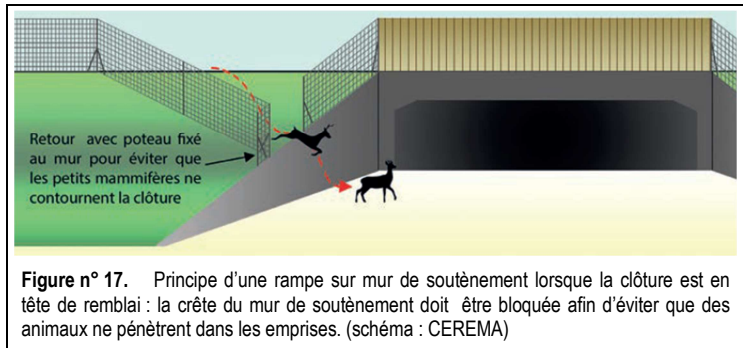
Principe d'une rampe sur mur de soutènement lorsque la clôture est en tête de remblai : la crête du mur de soutènement doit être bloquée afin d'éviter que des animaux ne pénètrent dans les emprises. (schéma : CEREMA)
